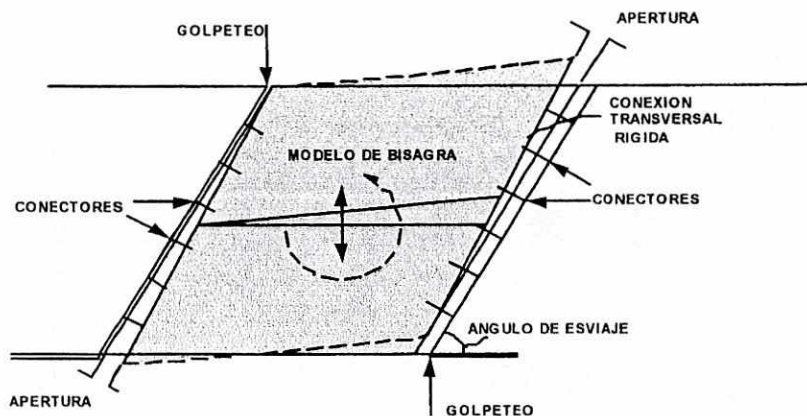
Planta de puente en esviaje y modelo de conexión rígida.
